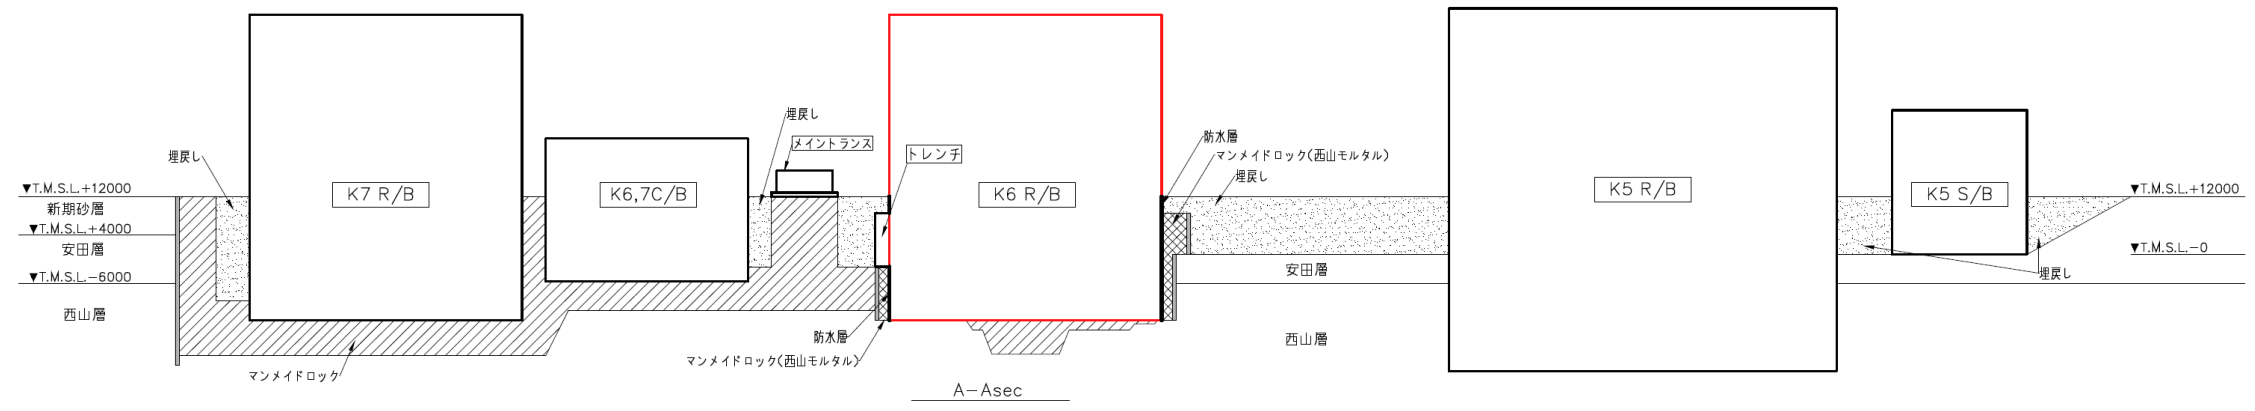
6号炉原子炉建屋の設置状況(平面図)
